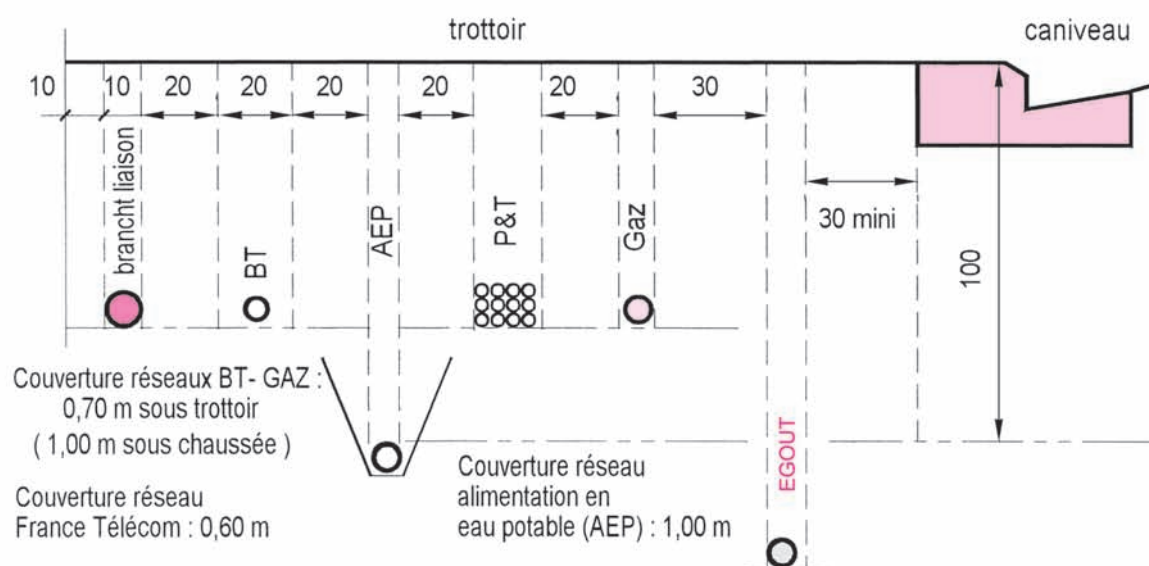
Coupe sur tranchée type avec différents réseaux
